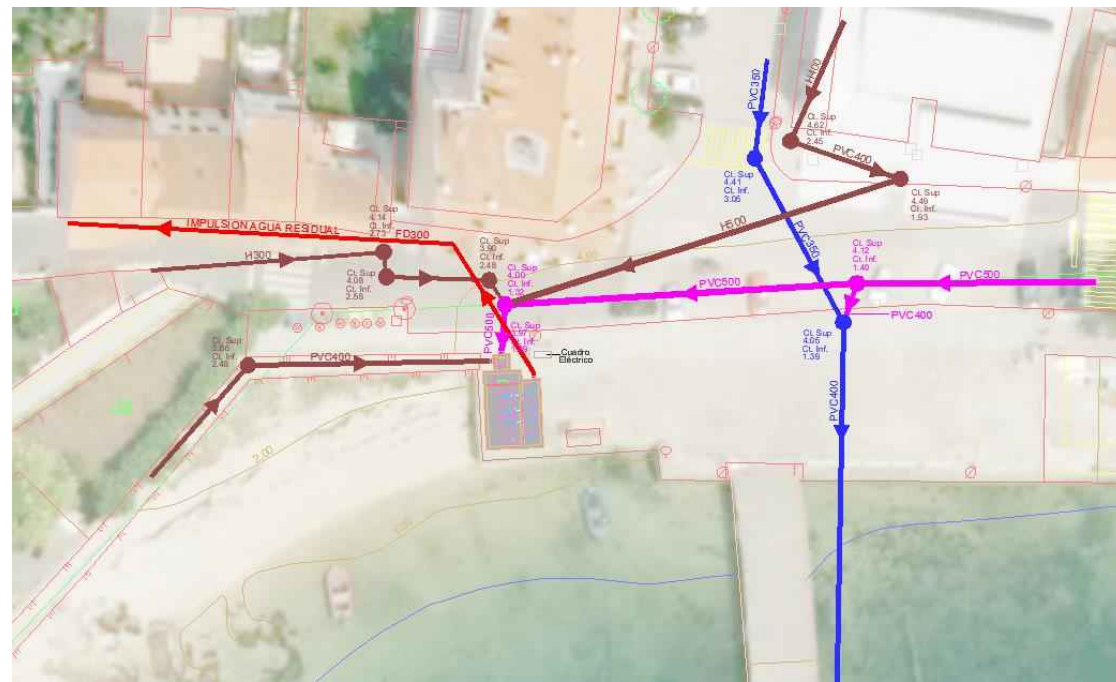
EBAR Concello. Planta general conexiones hidráulicas
